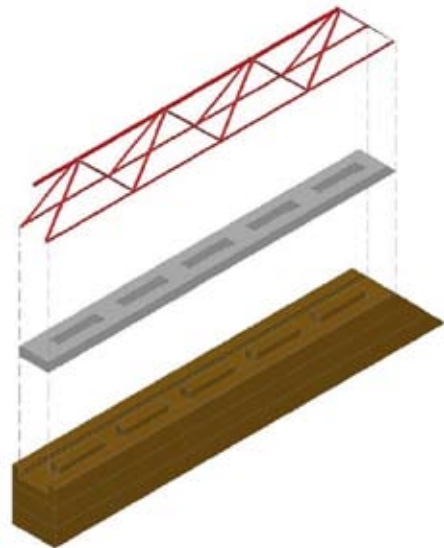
Assemblaggio del travetto in legno lamellare con il traliccio bausta e malta pissetropica.
